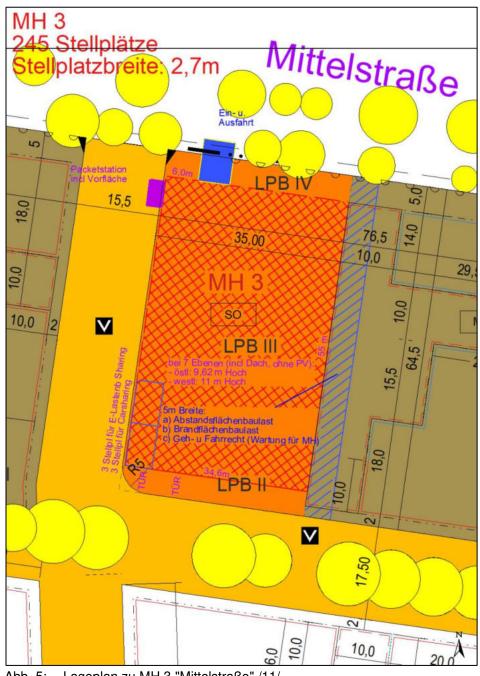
Lageplan zu MH 3 "Mittelstraße" /11/
